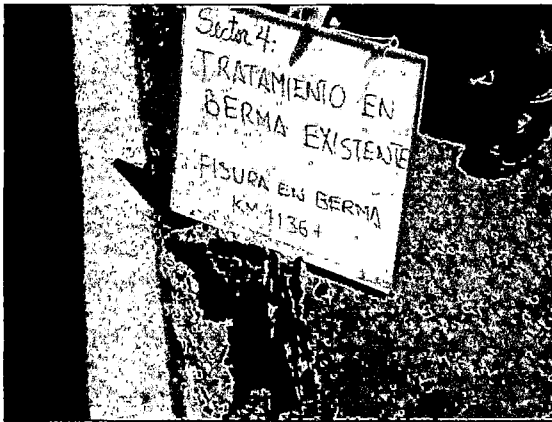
Las bermas existentes se encuentran también en mal estado, ellas pueden ser retiradas con la mano.
